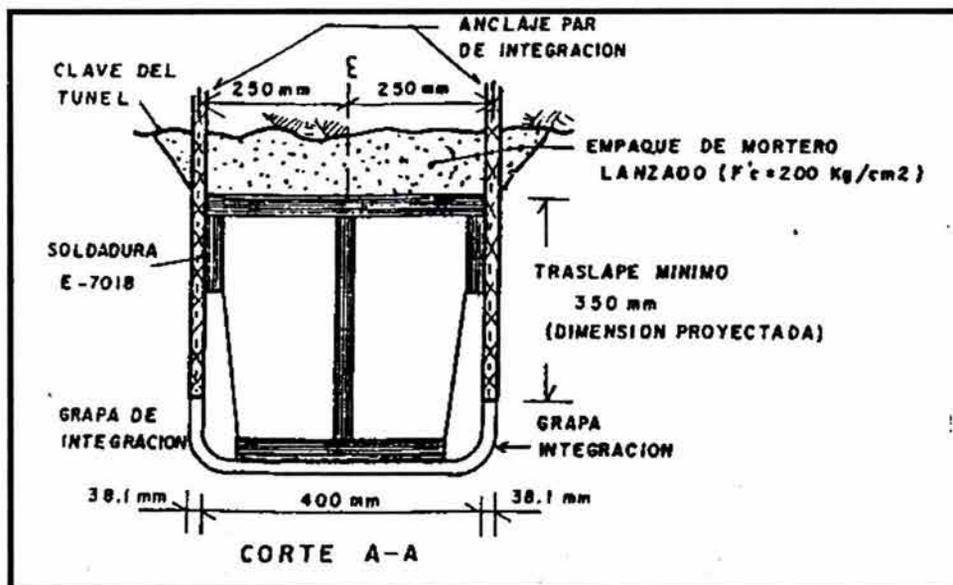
SUJECIÓN DE LAS VIGAS DE SOPORTE
